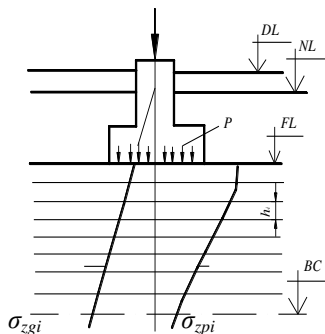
Розрахункова схема осідань фундаменту. Умовні позначення, що наведені на схемі:  $DL$  – позначка планування;  $NL$  – позначка поверхні природнього рельєфу;  $FL$  – позначка підшви фундаменту;  $BC$  – нижня межа товщі, що стискається
